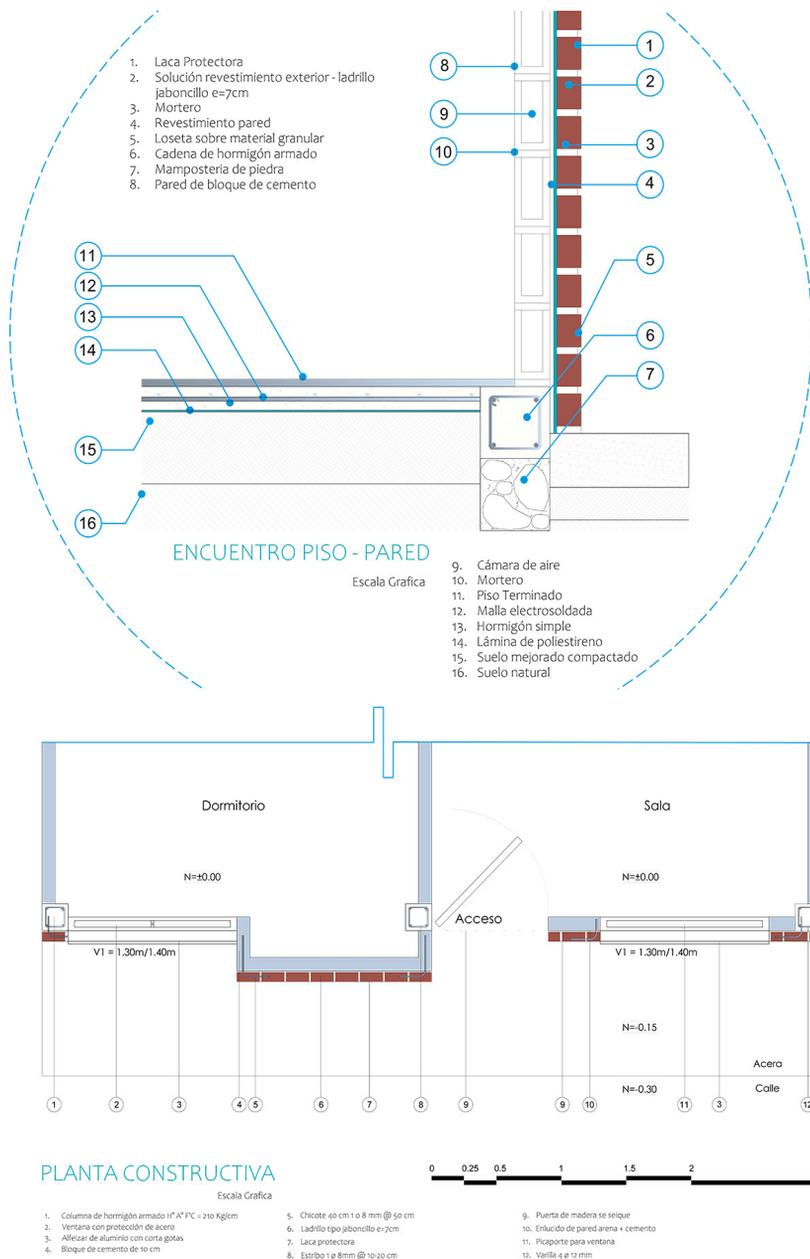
Detalles constructivos encuentro piso-pared de albañilería
